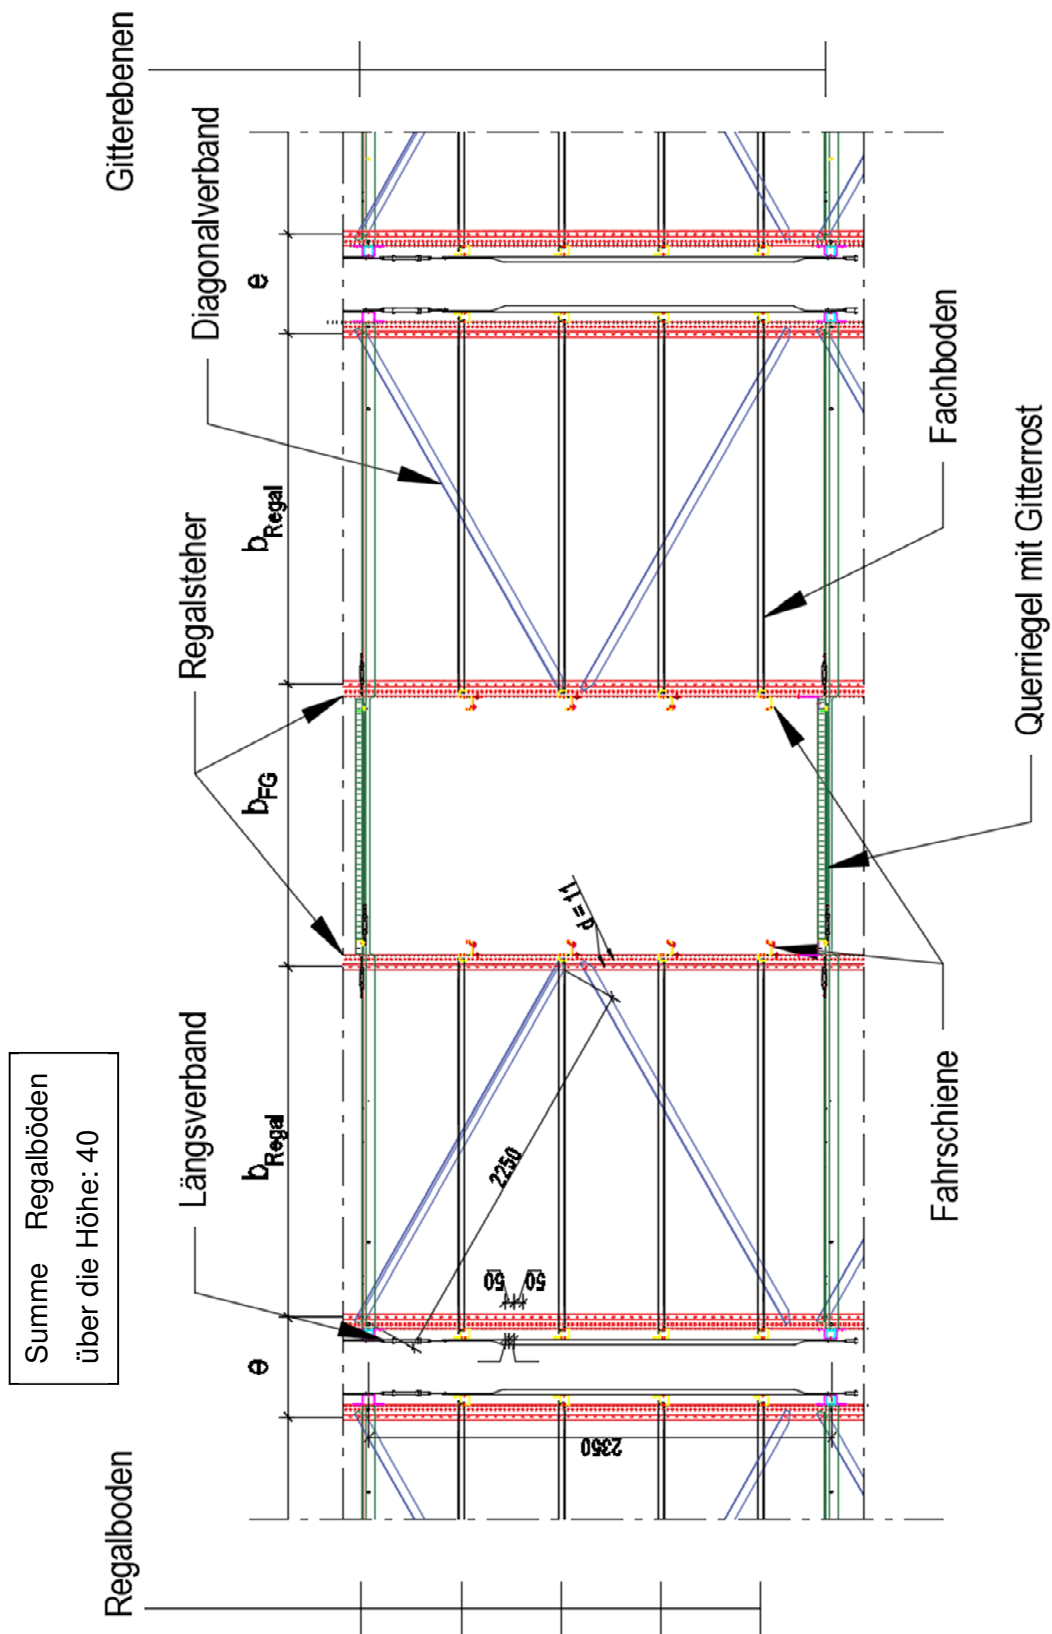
Detailansicht Quersystem (eine Ebene) mit Abmessungen und Bauteilen
